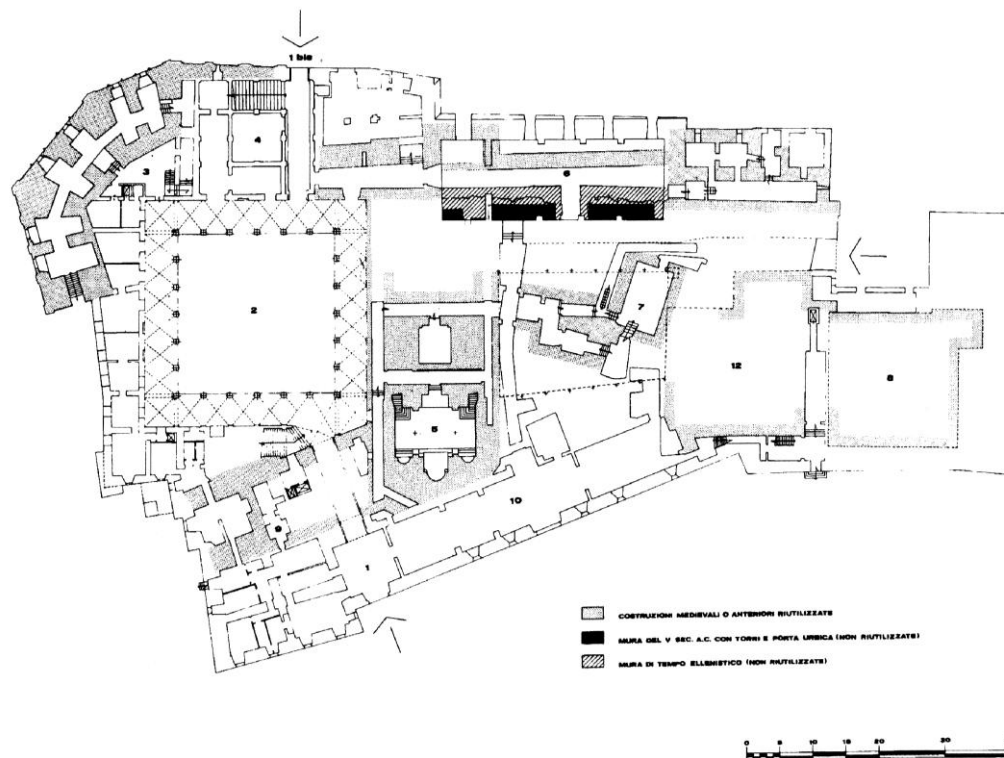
Palermo, Palazzo Reale, planimetria con indicazione delle strutture medievali superstiti (grigio) e delle mura puniche (nero e rigettato). Al numero 8 la Torre Pisana (CALANDRA 1991)
